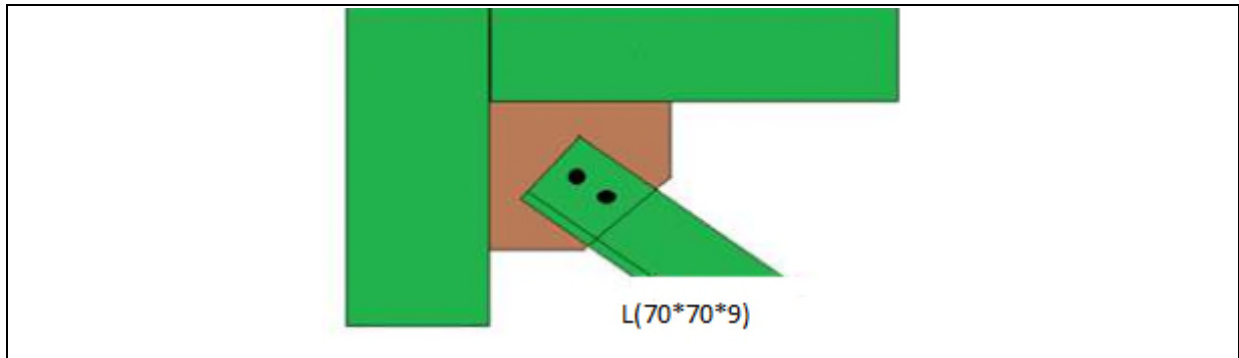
Assemblage diagonale de palée sur gousset.
